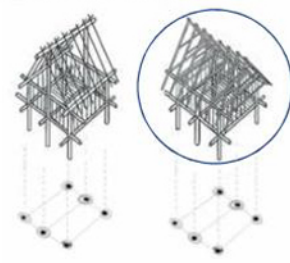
Deux propositions de restitution du grenier à six poteaux. (Dessin F. Epaud).
